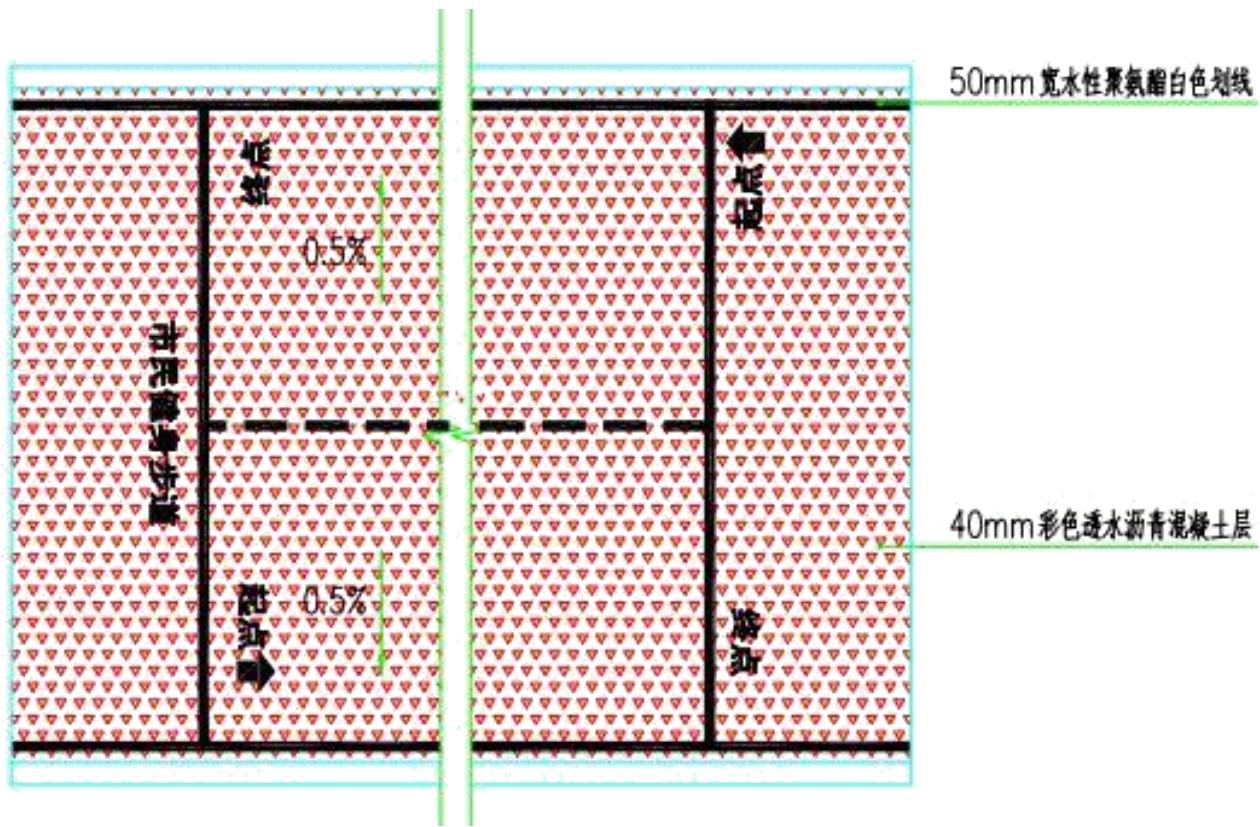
彩色沥青混凝土健身步道参考剖面图（单向）
